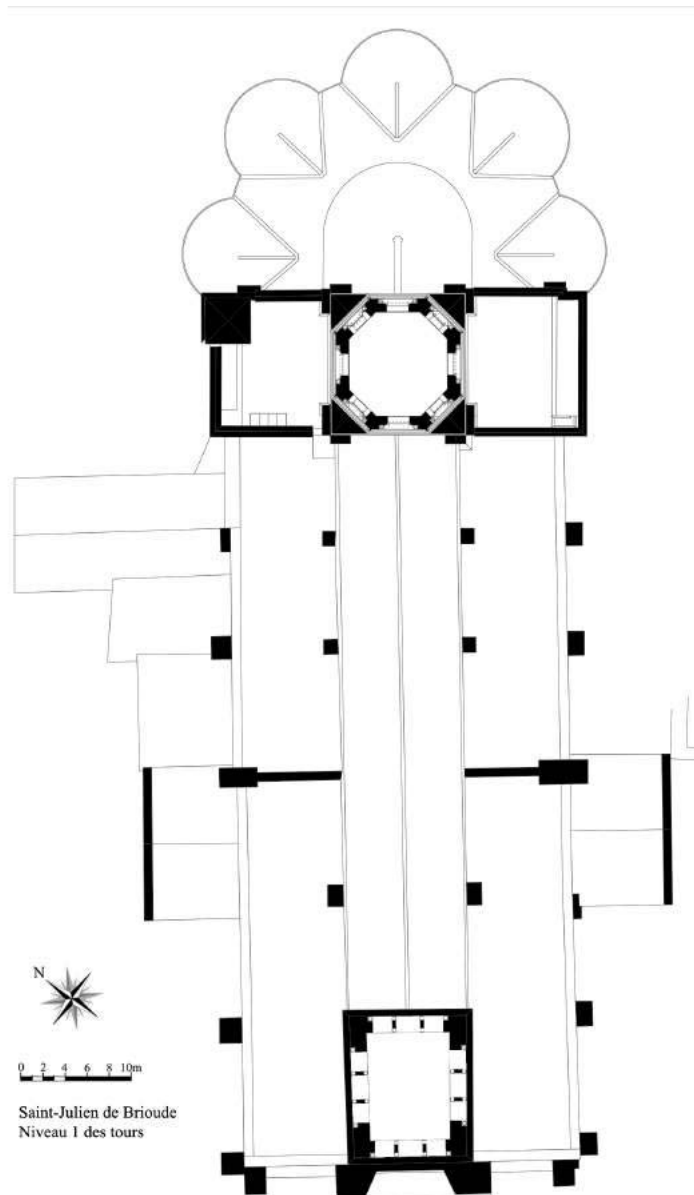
Fabien Vivier, Plan au niveau du premier niveau des tours
